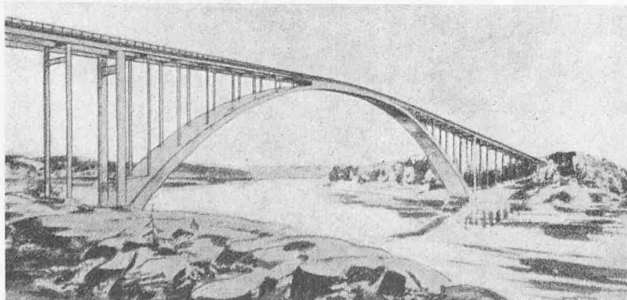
Sandö-Brücke. Ansicht des 264 m weit gespannten Eisenbetonbogens über den rechten Flussarm. Gesamtlänge 843 m, Betonmasse rd. 10 000 m<sup>3</sup>, Stahleinlagen rd. 1050 t
